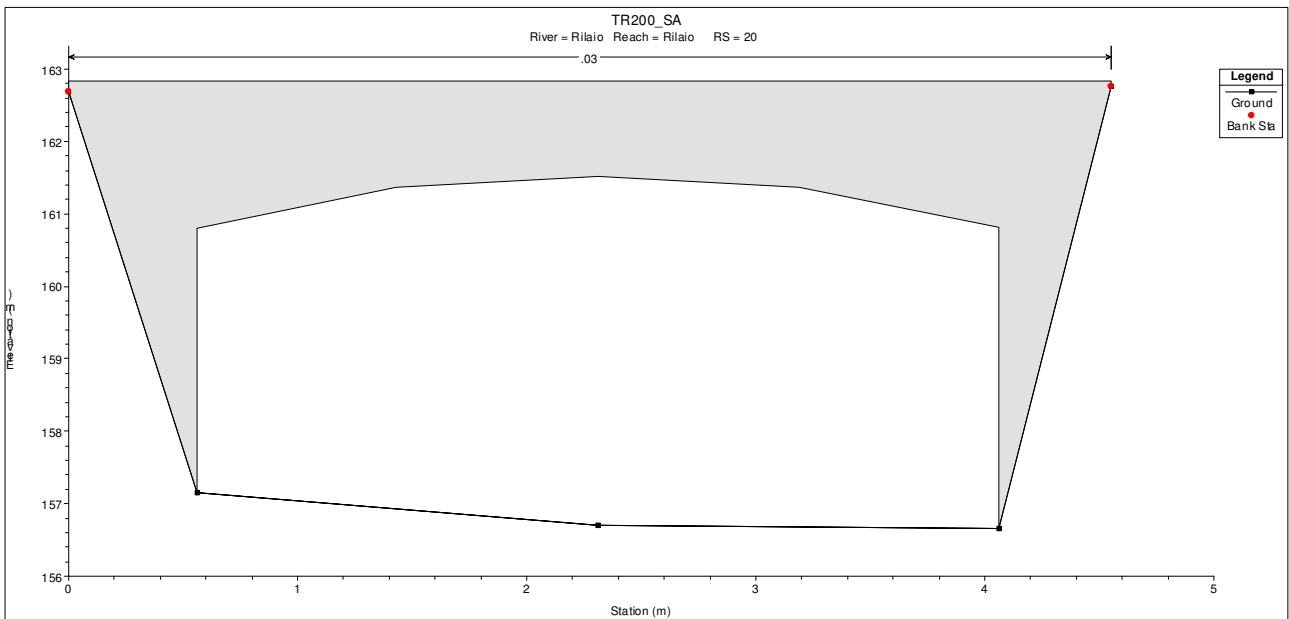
PONTE OGGETTO DI VERIFICHE - SEZIONE DI VALLE
